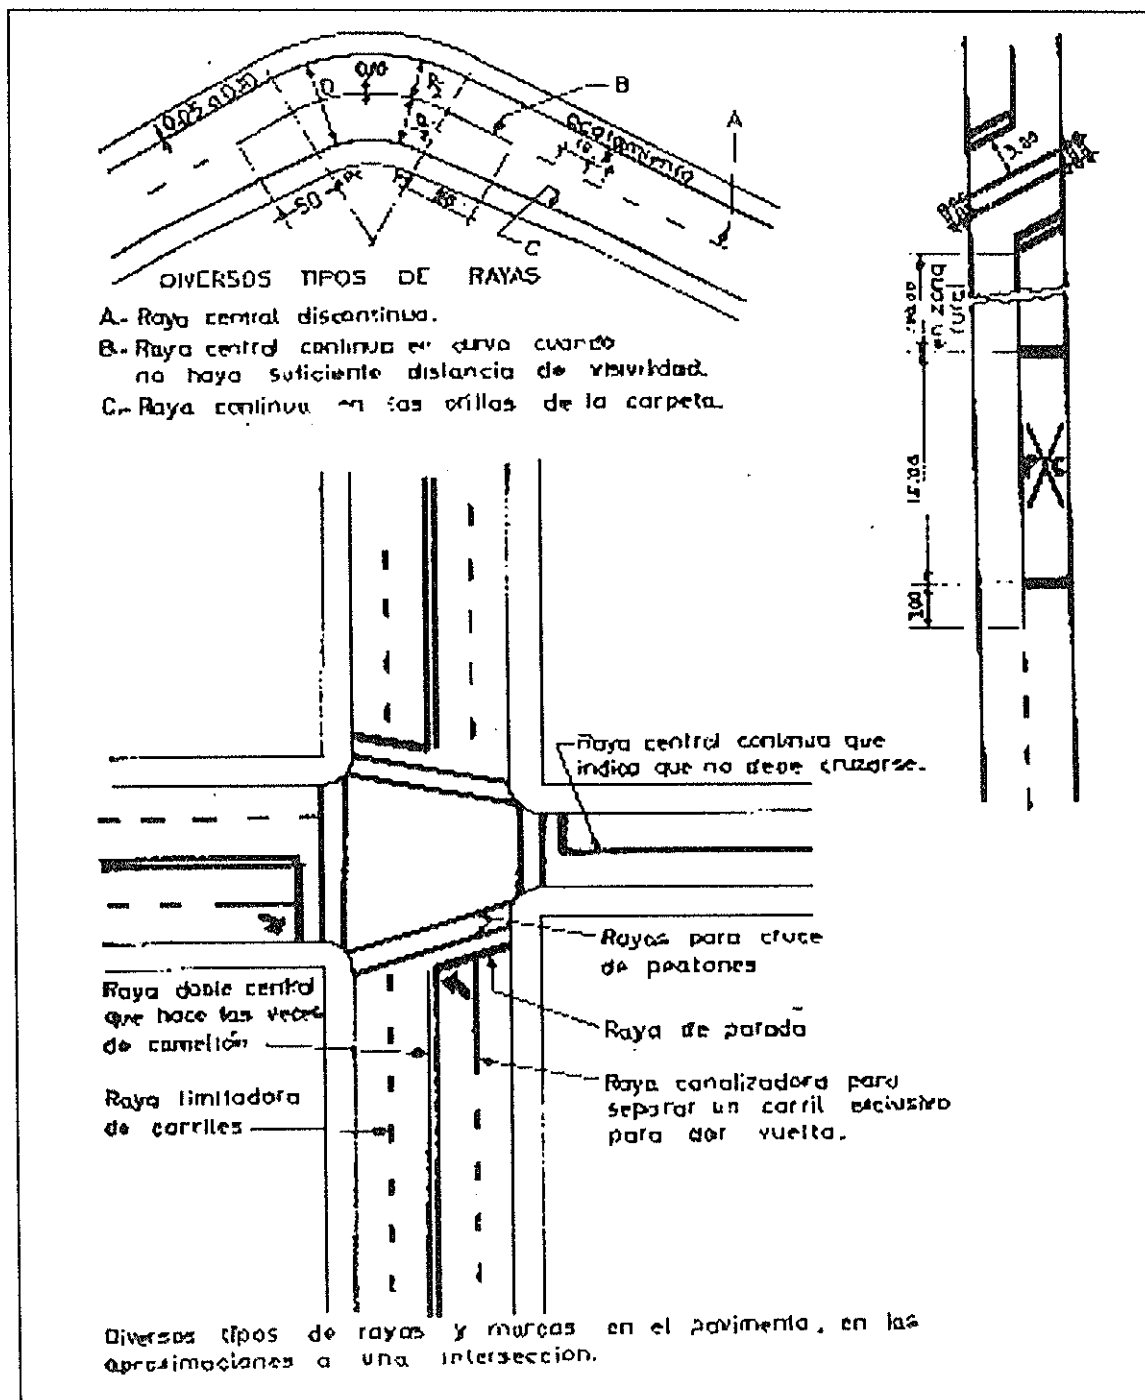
MARCAS SOBRE EL PAVIMENTO
